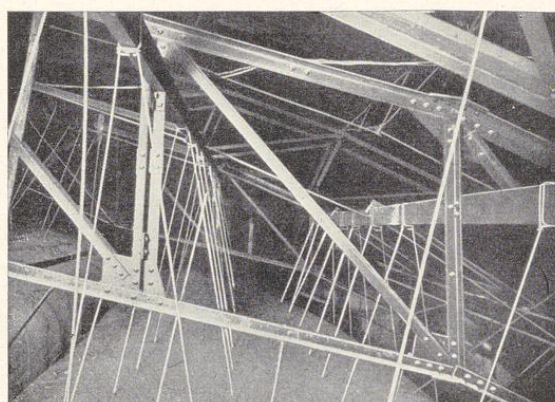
Gut angelegte Abhängung eines Rabitzgewölbes an eiserner Dachkonstruktion. Die Abhänger sind mit besonderen Schlingen geschlossen
